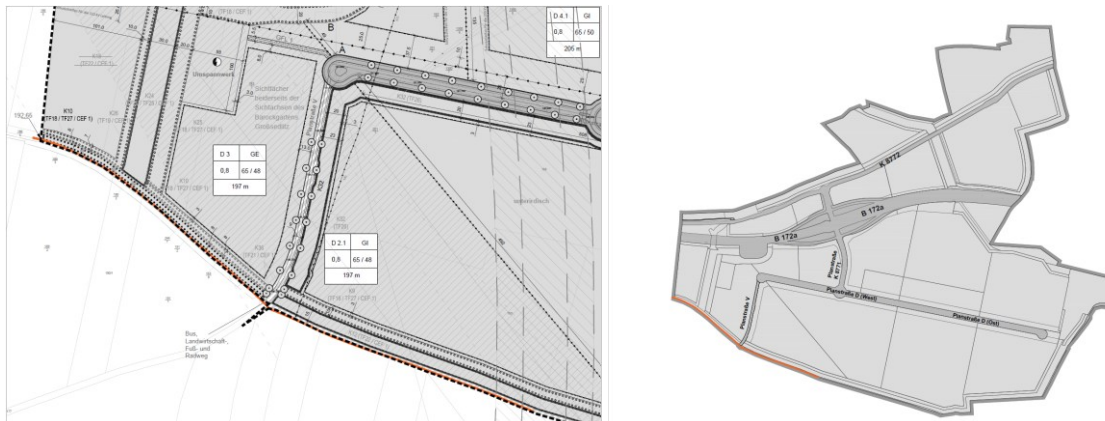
Lage der Gas- Hochdruckleitung (Orange) im Plangebiet
